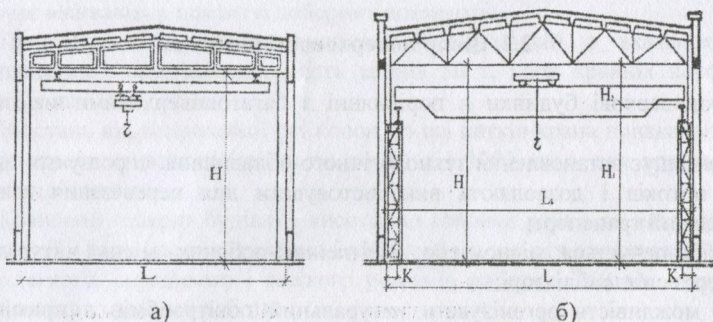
Будівлі з підвісним (а) і мостовим (б) кранами.
